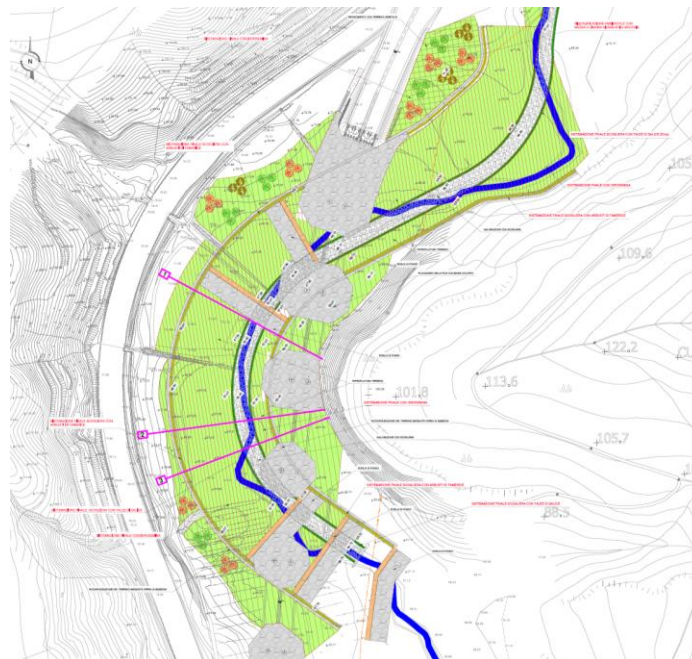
Planimetria interventi di progetto – viadotto Mesima 1
